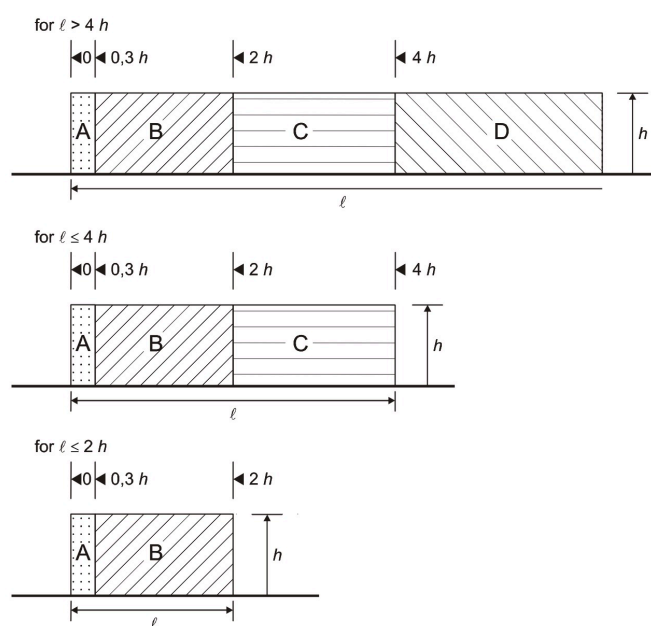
Zonas em paredes verticais (LNEC 2010)
